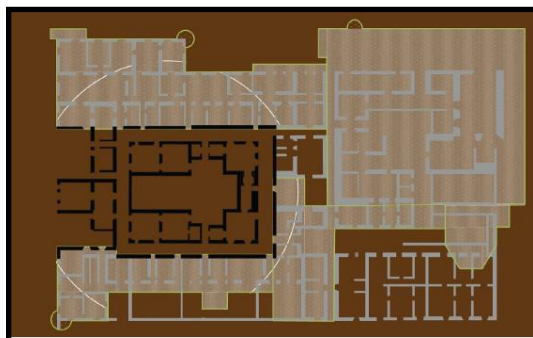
Planta do convento antes e após a construção do Palace Hotel – A cinzento pode visualizar-se a planta do convento antes da construção do Palace Hotel, a preto está representada a planta do Convento após a construção do Palace Hotel e a verde a planta do Palace Hotel
